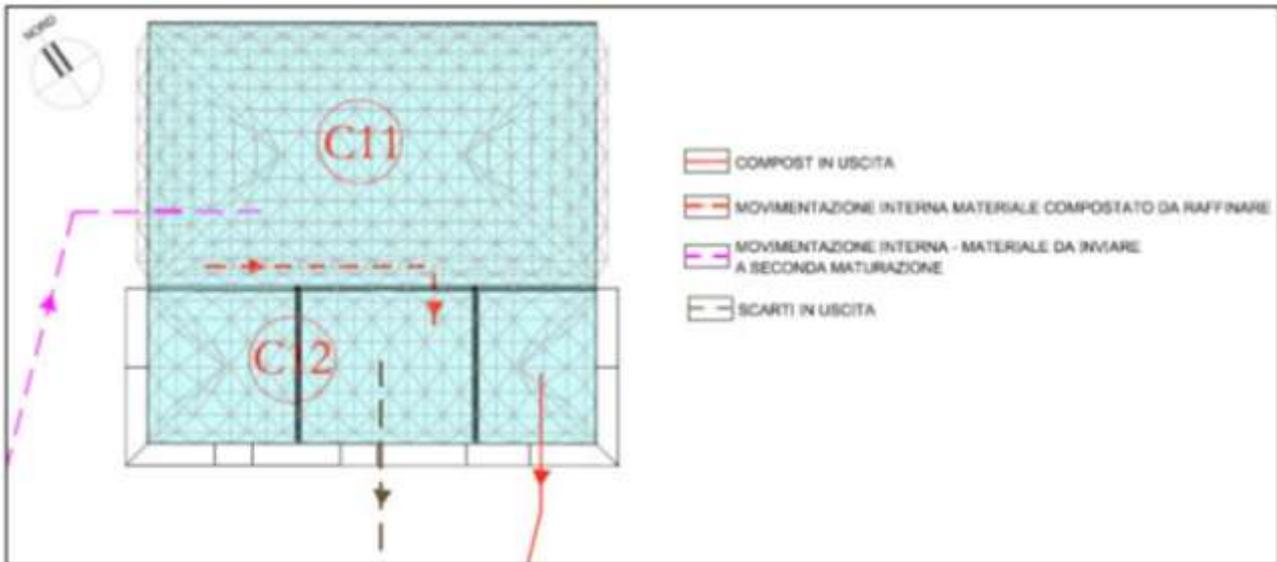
PLANIMETRIA CAPANNONE C11 E C12 – CON INDICAZIONE DELLE LINEE DI FLUSSO - STATO ATTUALE
